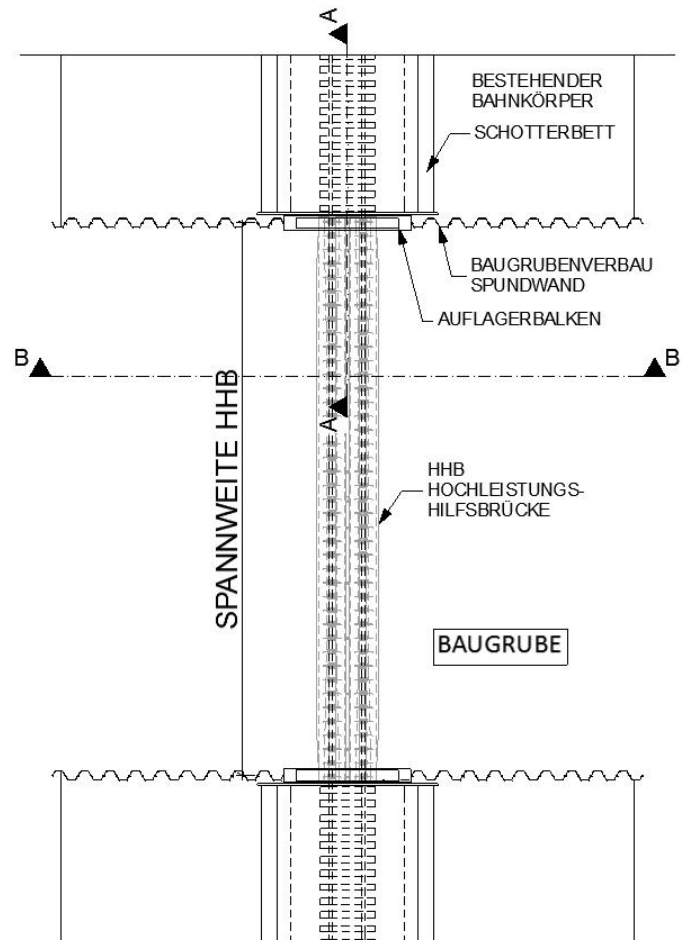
Ausgangssituation - Grundriss einer Baugrube - einseitige Strecke
